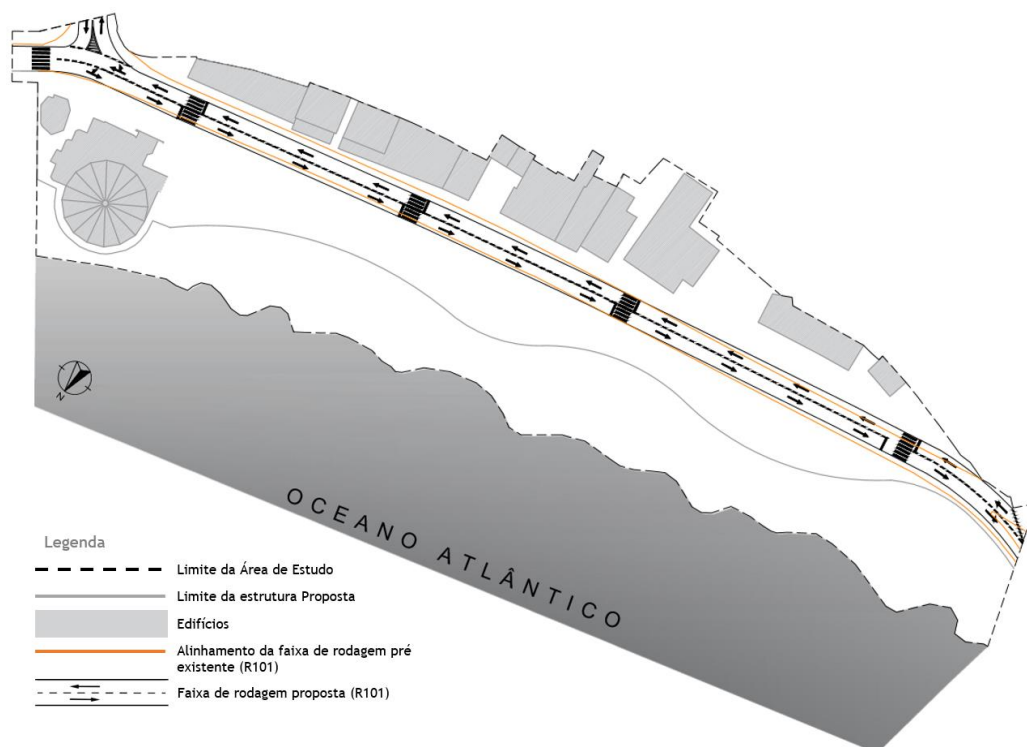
Planta esquemática: Zona do Calhau. Rede Viária. [s/escala]
